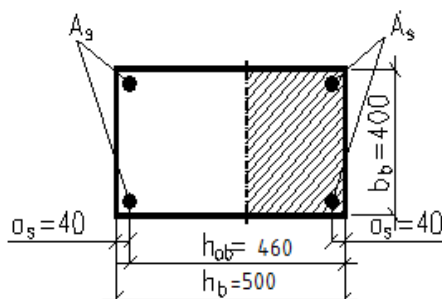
Поперечний переріз і схема армування підкранової частини колони.
